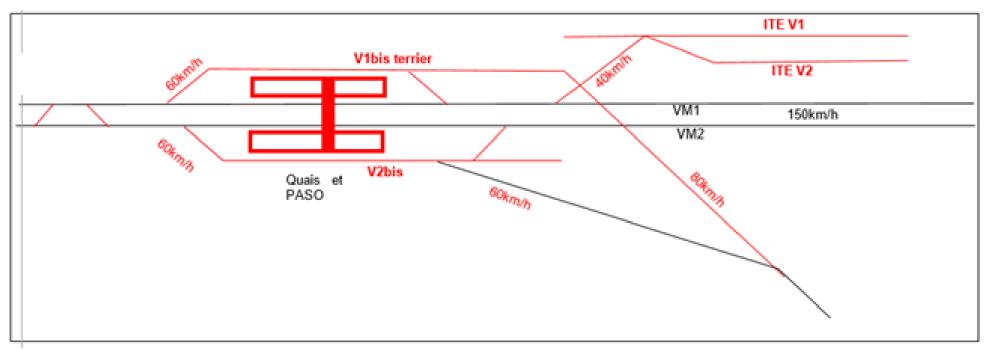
Plan de voie projeté (source : Egis, 2021)
